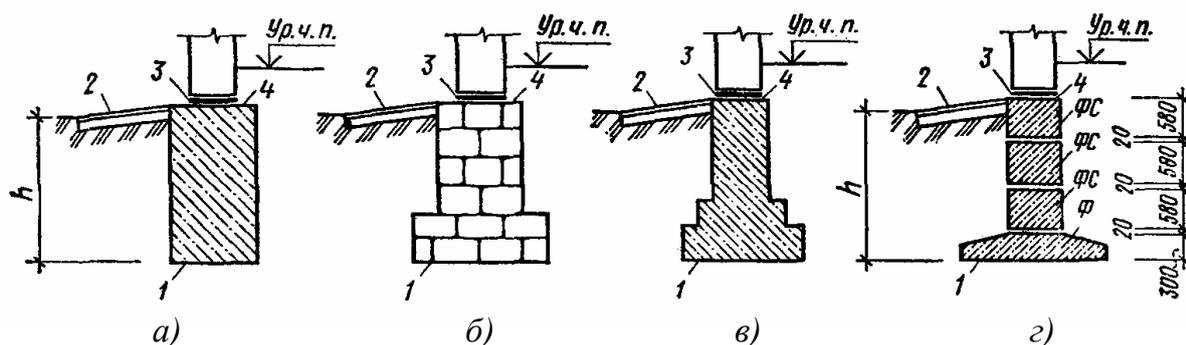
Поперечные сечения ленточных фундаментов: а – из бутобетона прямоугольного сечения; б – из бута с уступом; в – из монолитного бетона с двумя уступами; г – из сборных бетонных блоков; 1 – подошва; 2 – отмостка; 3 – гидроизоляция; 4 – обрез; h – глубина заложения фундамента; ФС – блок фундаментный стеновой; Ф – фундаментная плита
